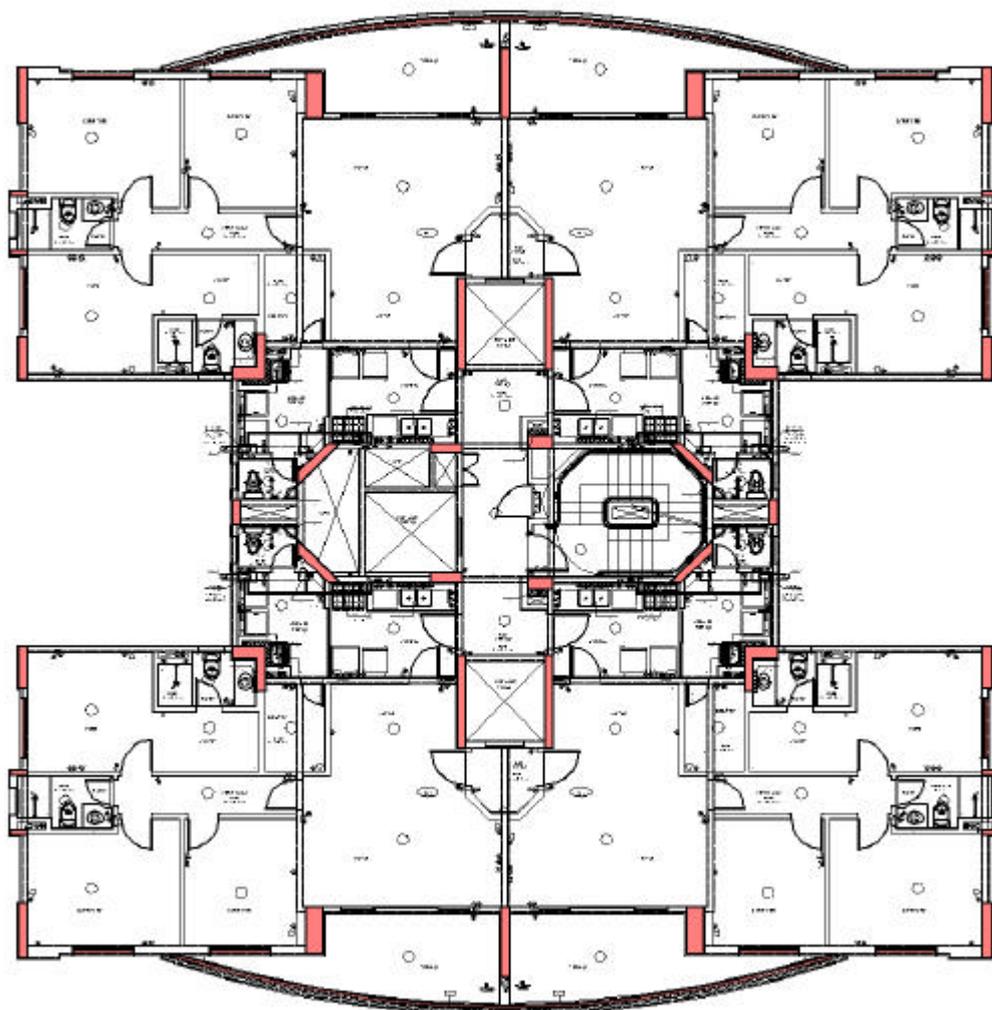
Planta geral do pavimento-tipo analisado no caso 1.
